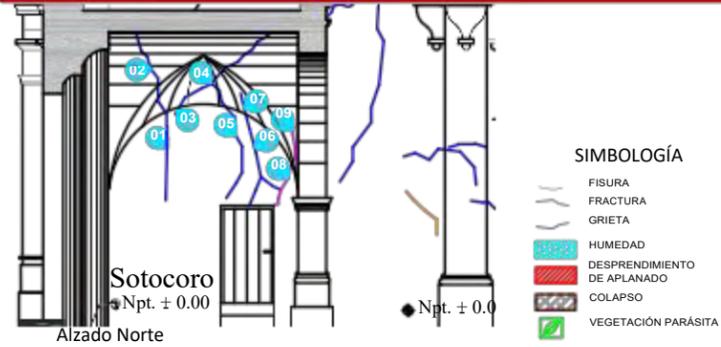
Detalle de afectaciones en intradós de cubierta y muro adyacente parte poniente
